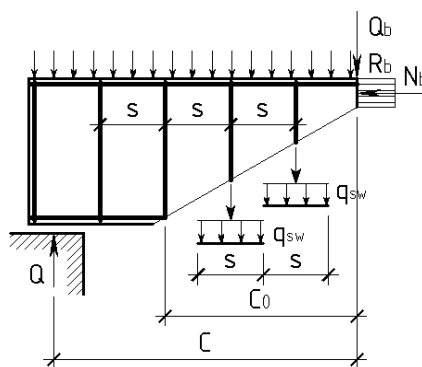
Схема внутренних усилий в балке, армированной поперечной арматурой от действия поперечной силы
